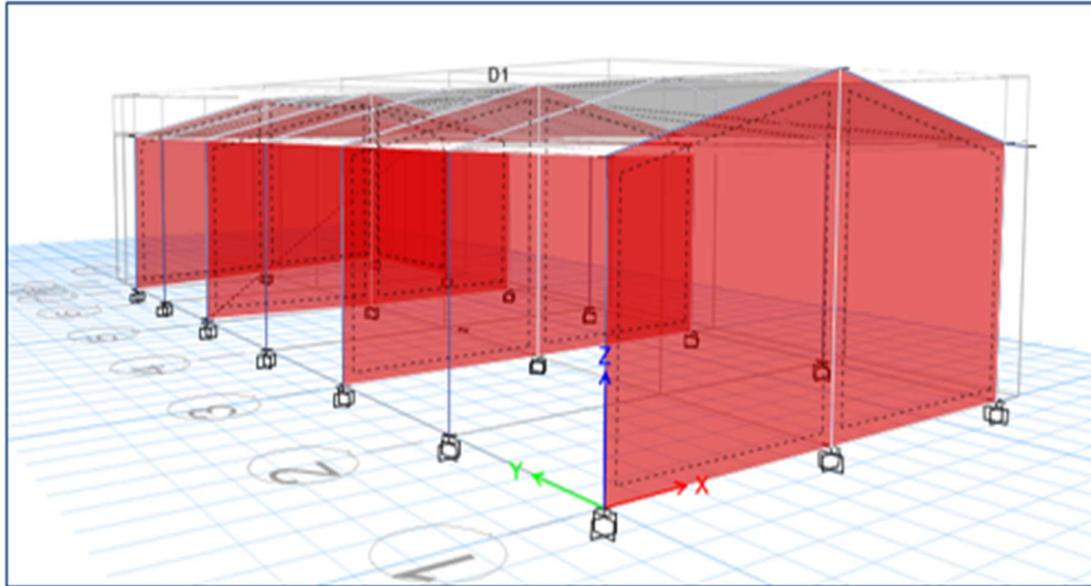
ETABS, Ubicación 3D de Muro de Albañilería en Pórtico del Eje Y-Y.
